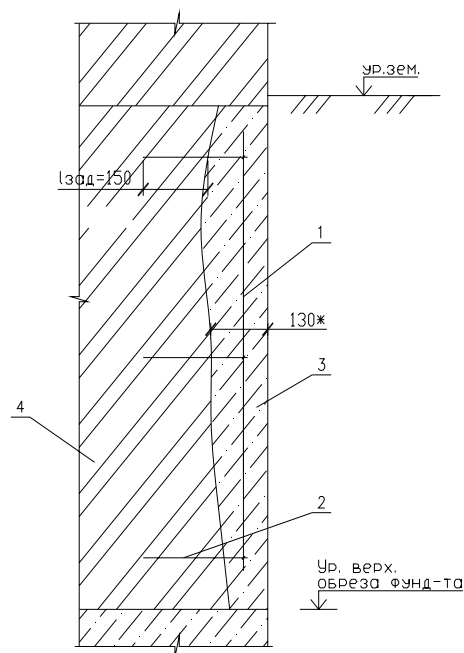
Конструкция восстановления кладки цокольной части стен, получившей серьезные повреждения в результате размораживания : 1 – сетка «рабица», 2 – анкер из арматуры класса А-III, d=8мм, шаг 600мм, 3 – монолитный бетон класса В15, 4 – кирпичная кладка цокольной части стены
